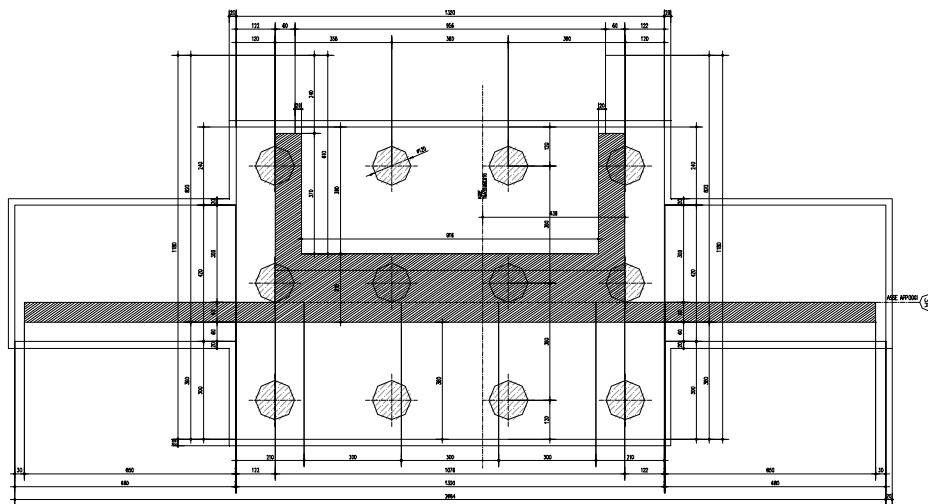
Spalla SA- Pianta fondazioni
